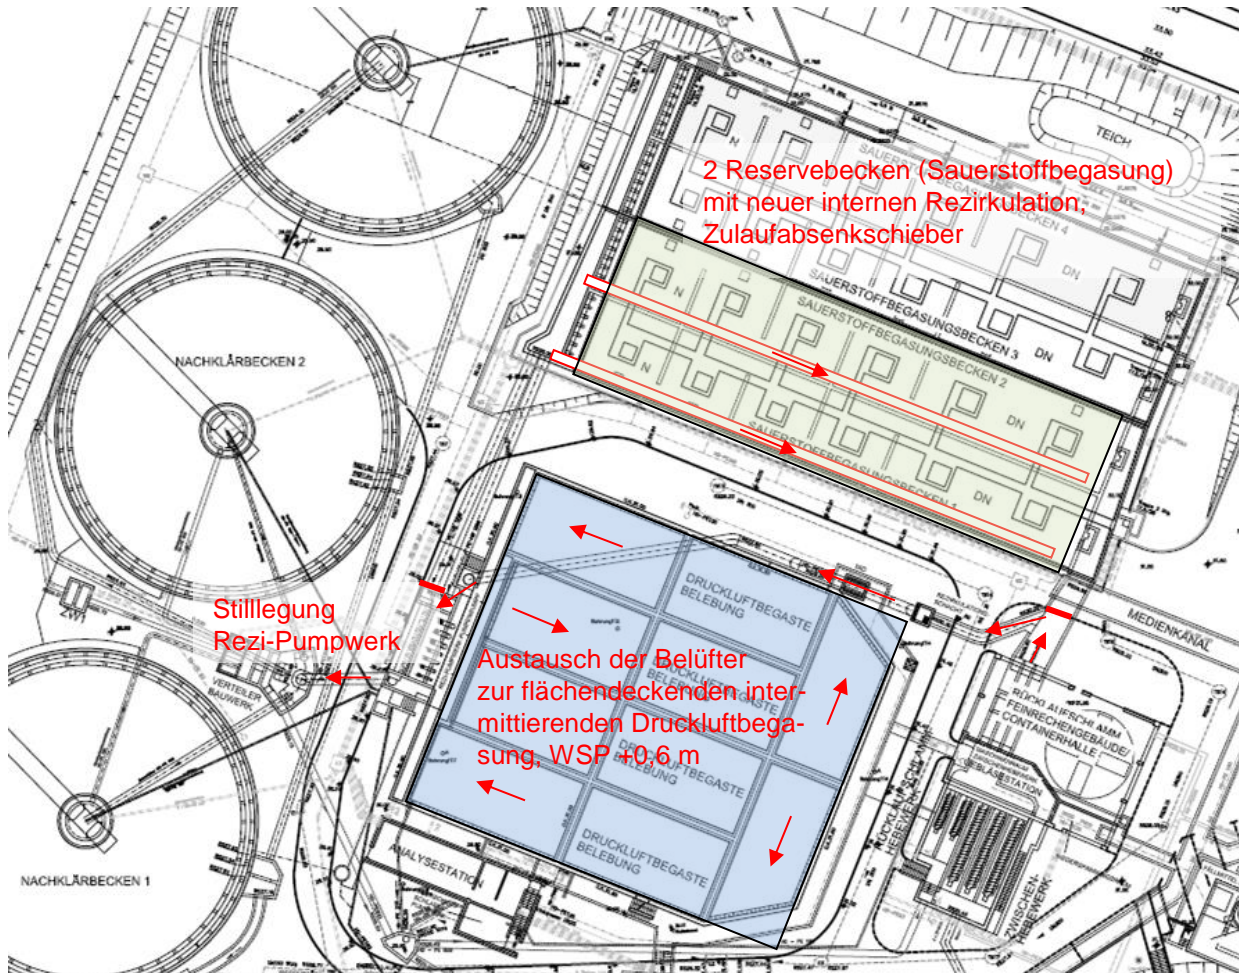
Lageplan Kläranlage Hochfeld – Umrüstung auf intermittierende Denitrifikation, Variante 1b
